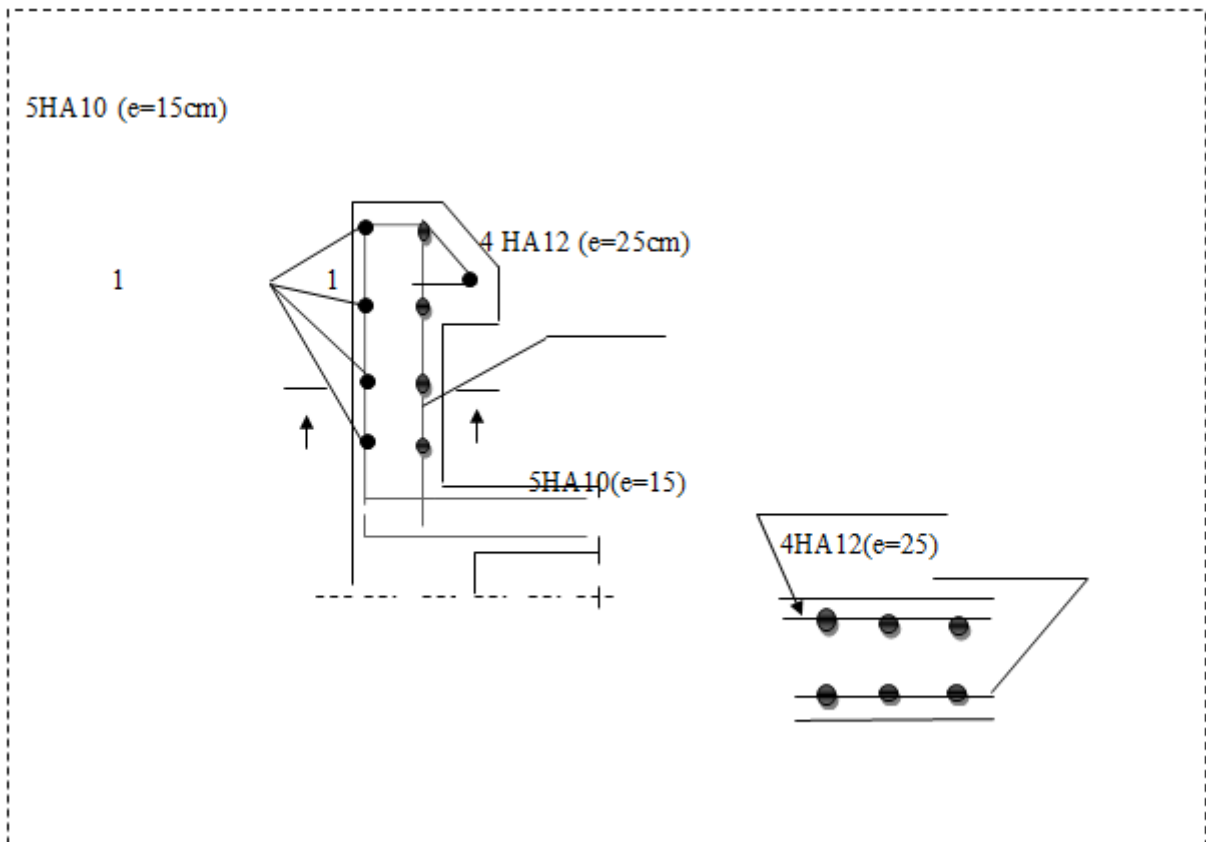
COUPE 1-1 Ferrailage d'acrotère
